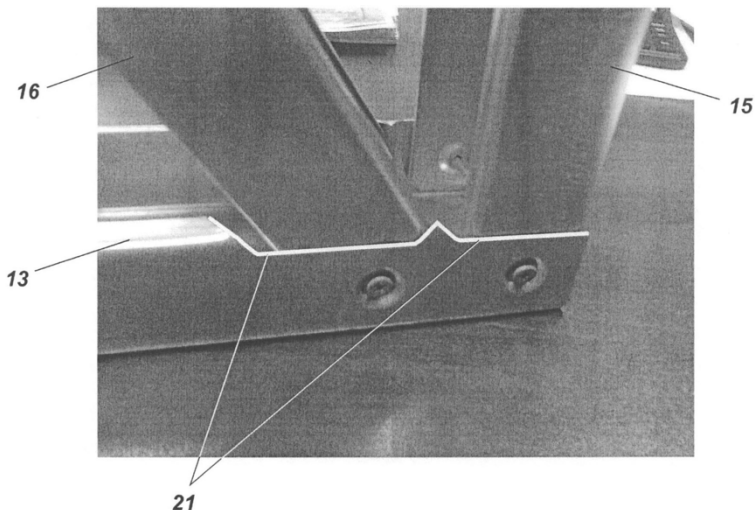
Фрагмент пространственной фермы: соединение элементов пространственной фермы арматурного каркаса [4], где: 13 – нижний пояс; 15 – соединительные стойки; 16 – соединительные раскосы; 17 – вырез.
